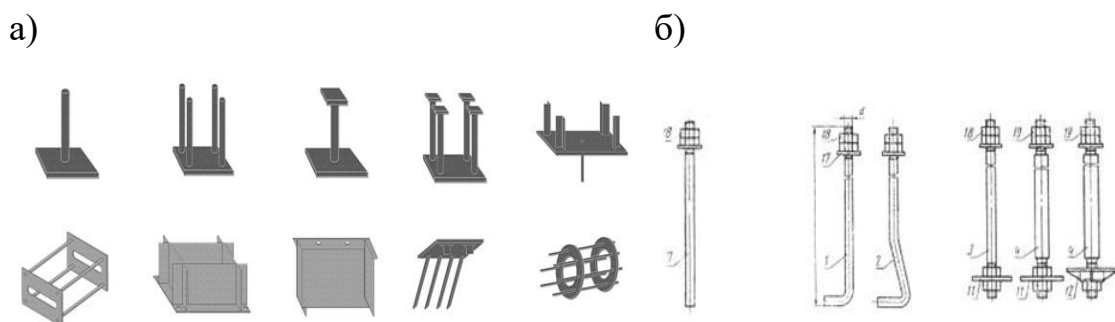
Закладні деталі (а) та анкерні болти (б)
